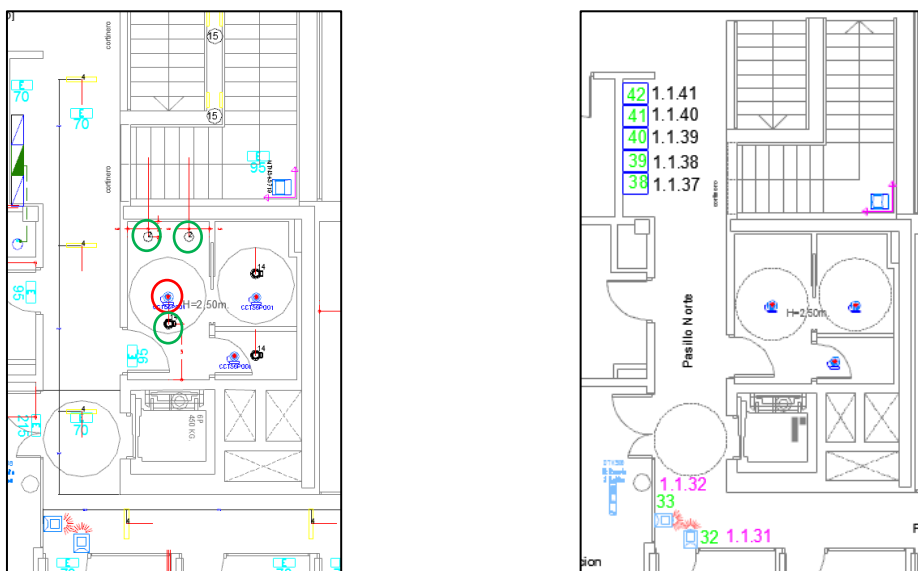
Iluminación Planta Baja y nº 7.21 Distribución de elementos KNX en Planta Baja
